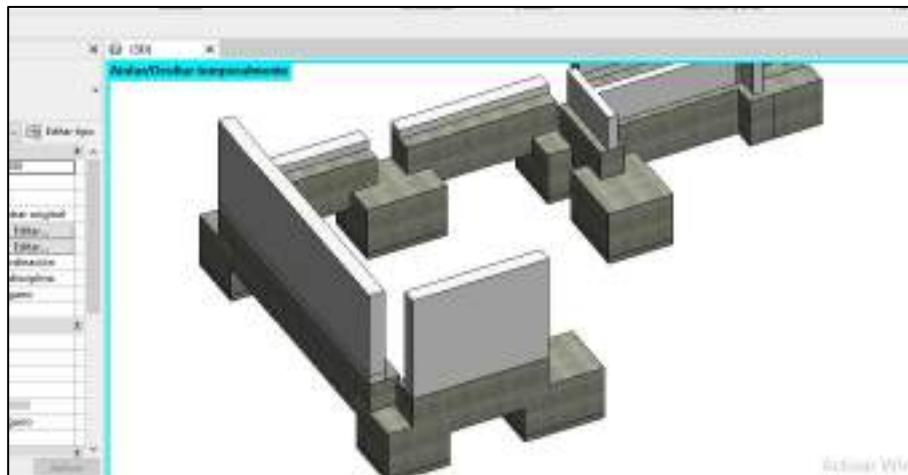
Modelamiento de las cimentaciones y zapatas del edificio.
